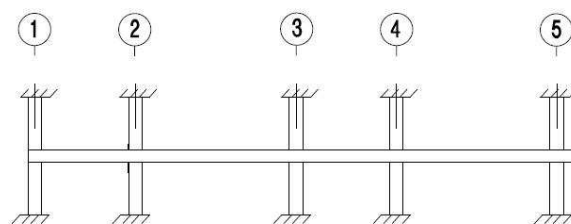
Elevação do pórtico da faixa B da laje, AALAMI e KELLEY(2001).
